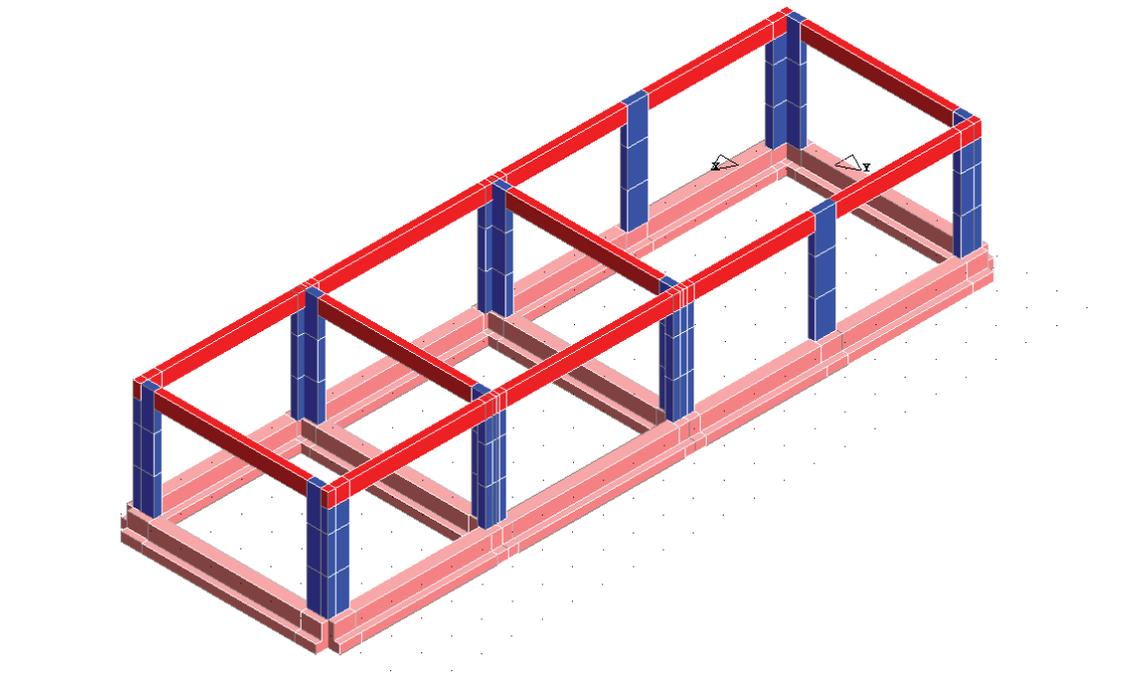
Rappresentazione tridimensionale della struttura (vista posteriore)
